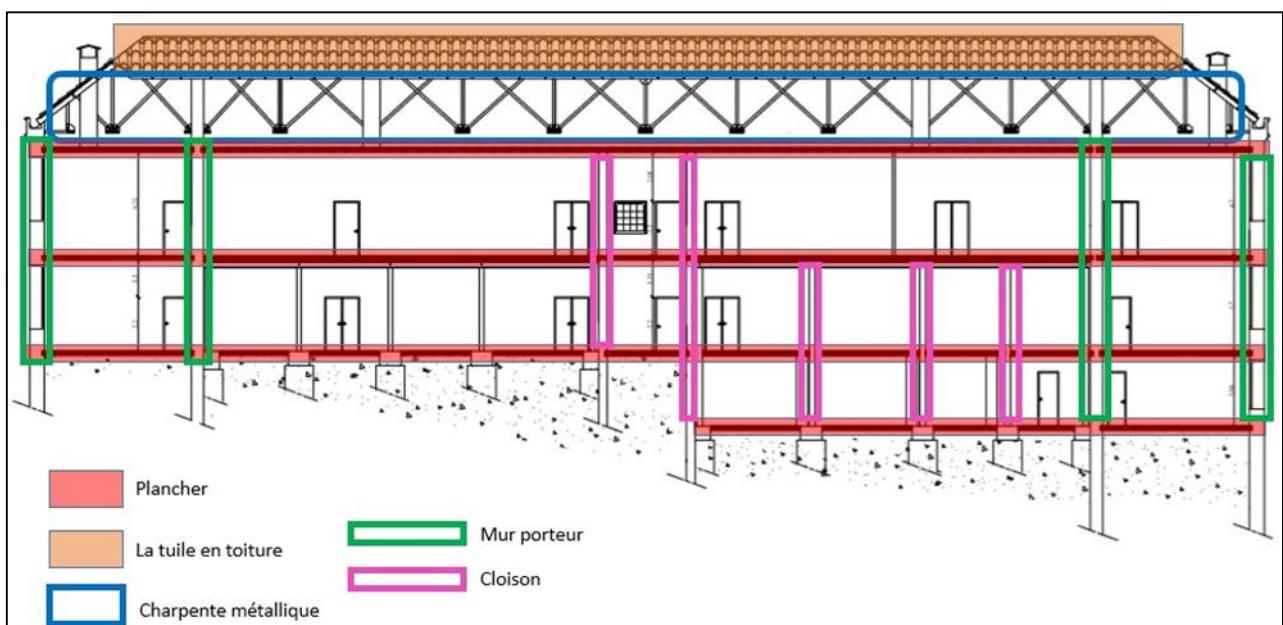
Coupe sur le bâtiment montrant les différents éléments de construction (Fond : BET Mr MAHINDAD. Traitement : auteur2025.).
